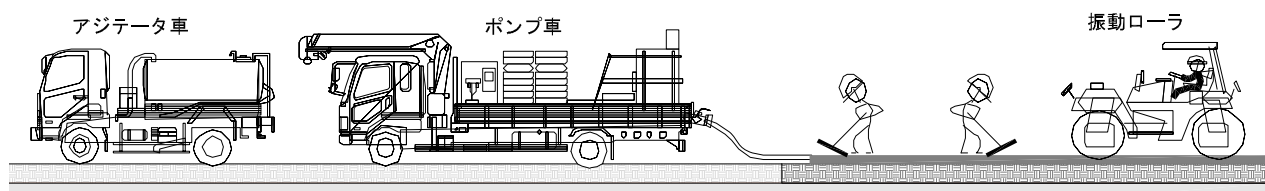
半たわみ舗装（セメントミルク注入）の施工状況
